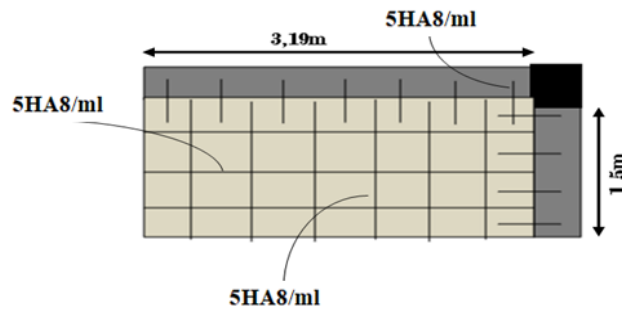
Schéma de ferrailage de la dalle pleine type N° 1.
